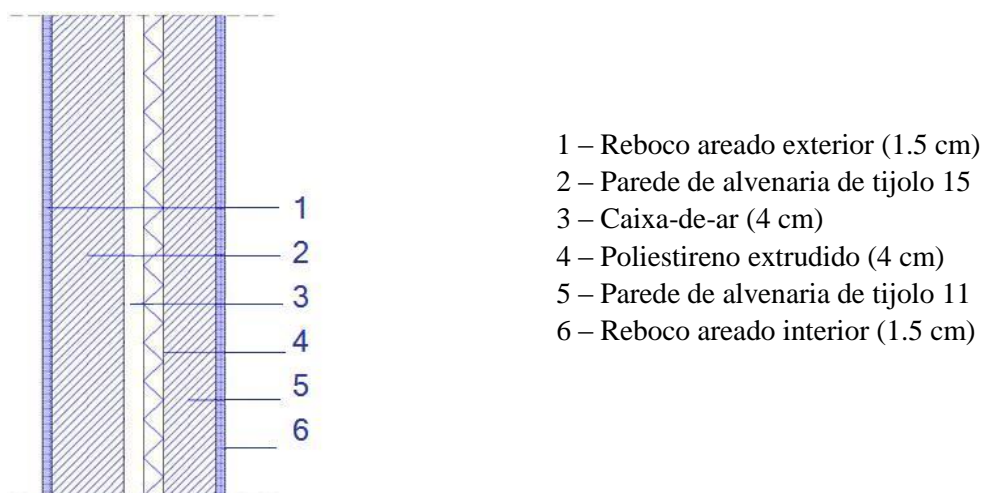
Pormenor construtivo da parede exterior de alvenaria de tijolo
